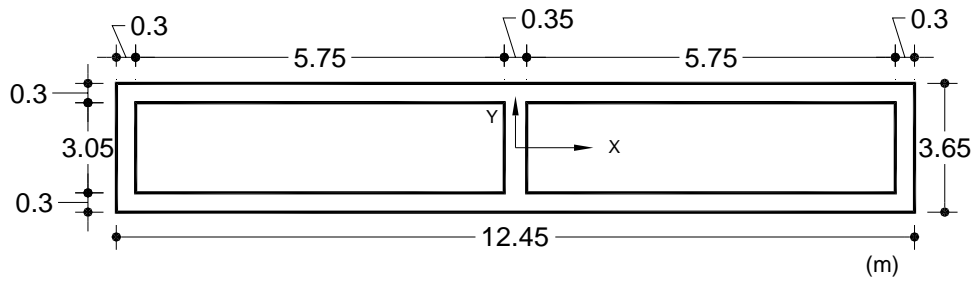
Sección 3 de la columna 9. (No. 9)
